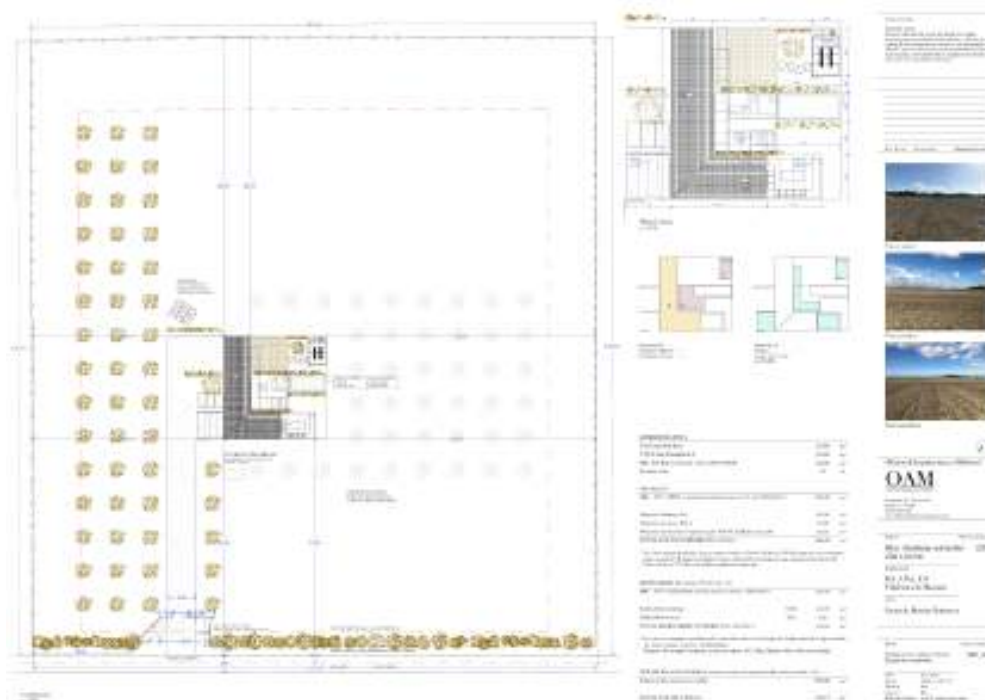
Plànol 2 planta baixa. Font: Gabriel Oliver Galmés
